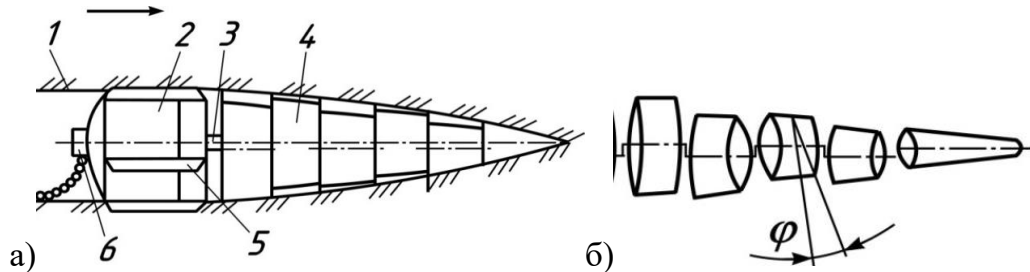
Формування свердловин розкочуванням ґрунту: а – принципова схема; б – схема розвороту котків; 1 – свердловина; 2 – привод; 3 – ексцентриковий вал; 4 – конічні котки; 5 – ребра-ґрунтозачепа; 6 – кабель або гідравлічний шланг
